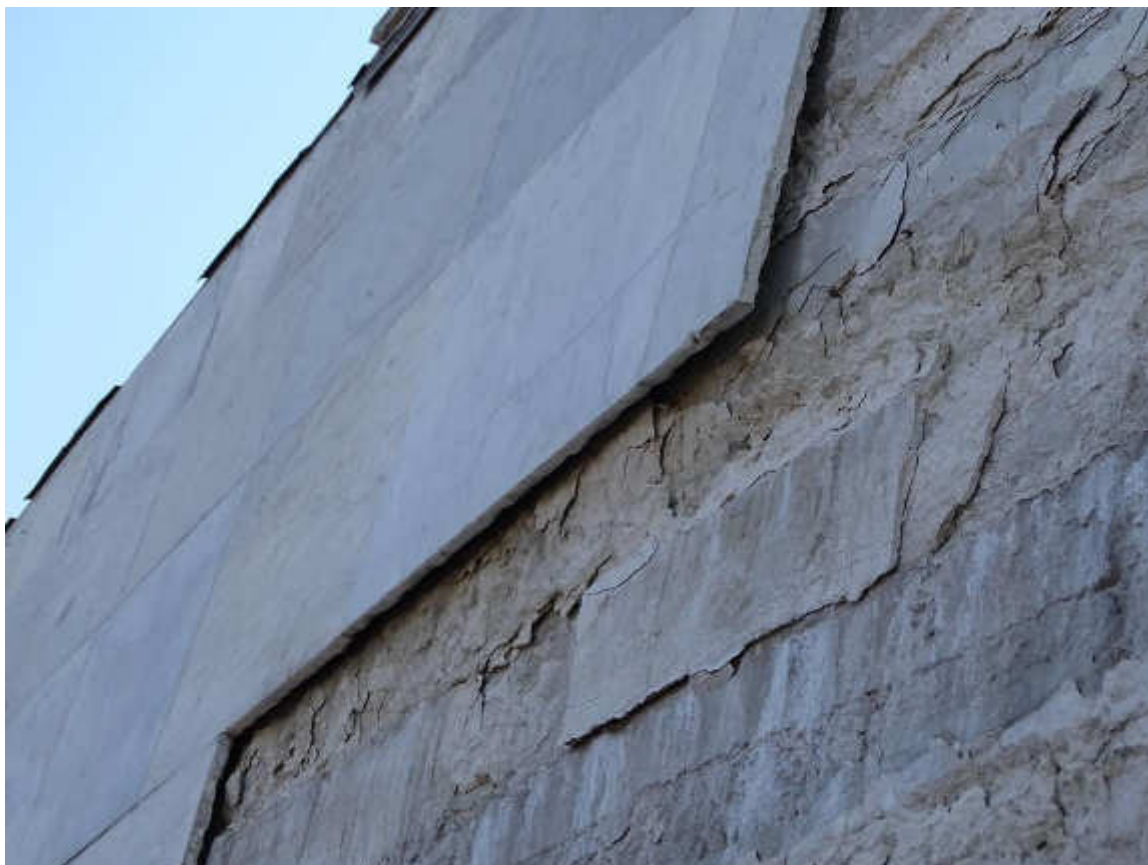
Фрагмент фасада в процессе демонтажа облицовки из мрамора, вид бетонного набрызга и отслоение облицовочных плит.
